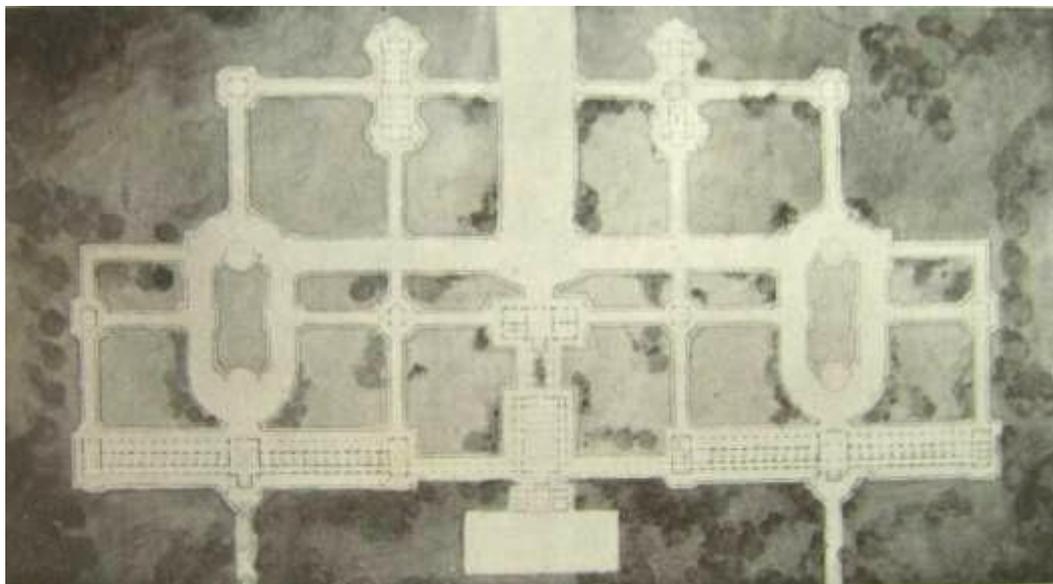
Projeto para Sanatório em Campos do Jordão - Planta Geral
